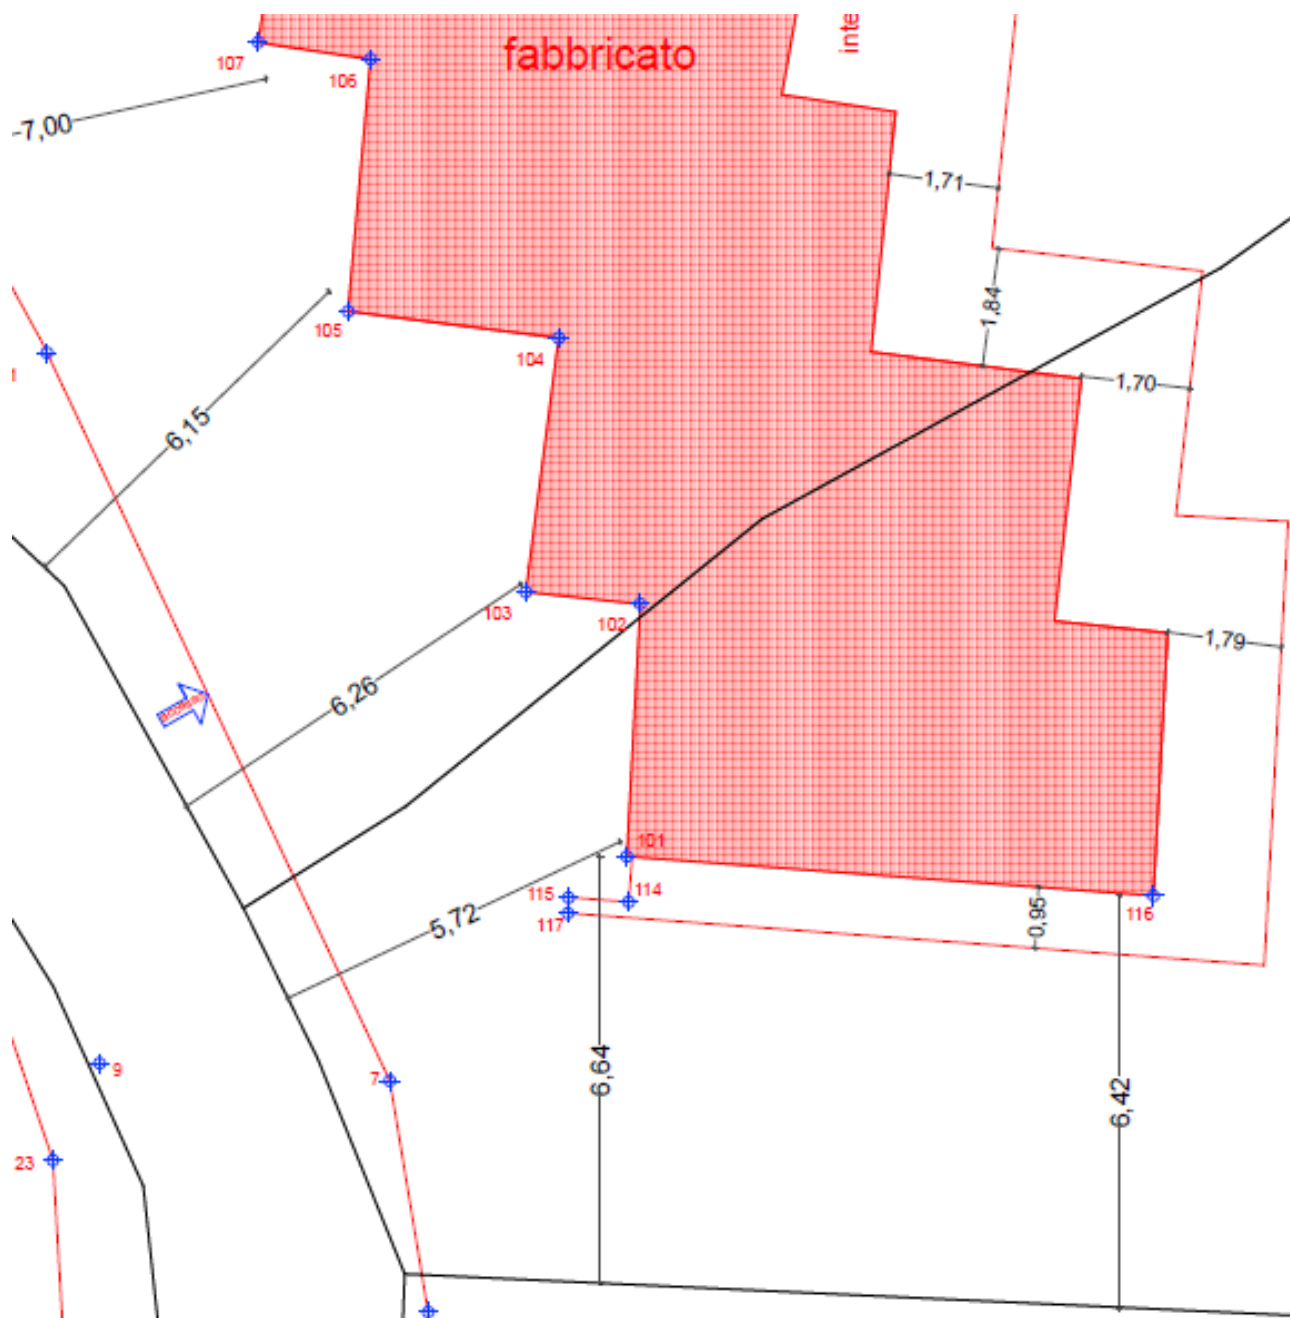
Rilievo planimetrico ed inquadramento catastale – zoom porzione Nord
